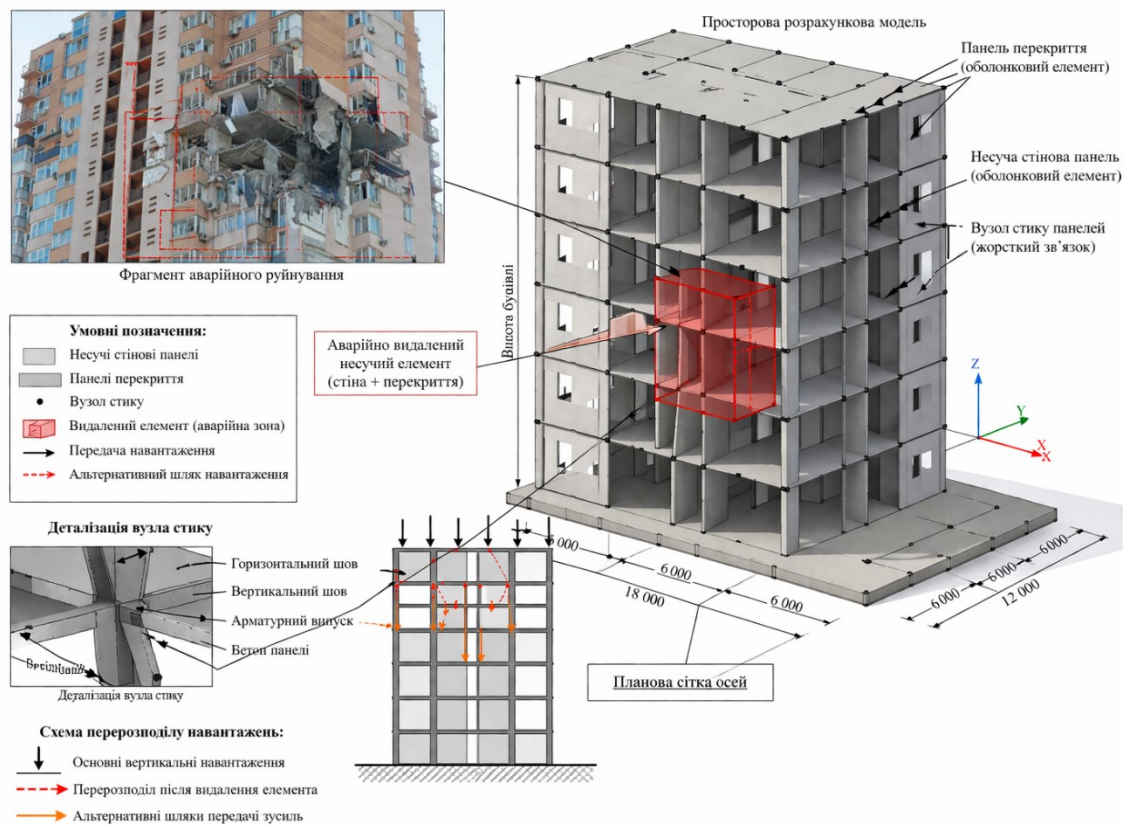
Просторова розрахункова схема панельної будівлі з позначенням аварійного видалення елемента
